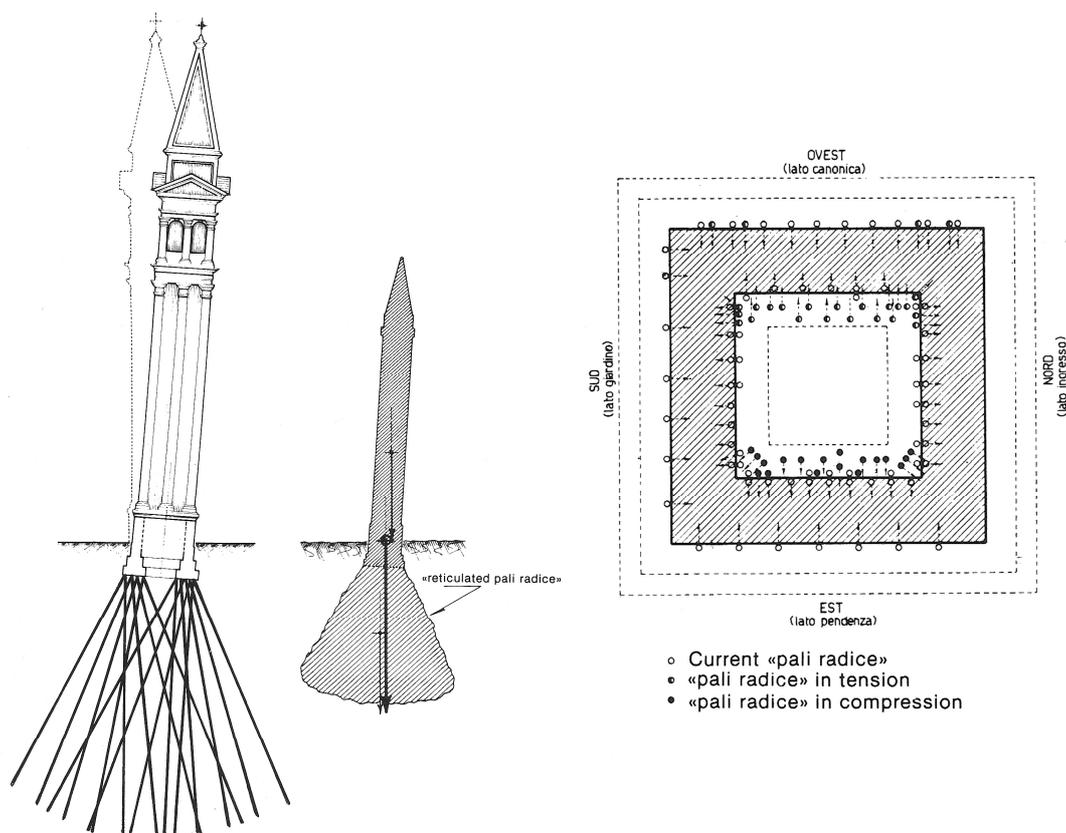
Campanile di San Martino: reticolo di pali “Radice” in fondazione [10]
